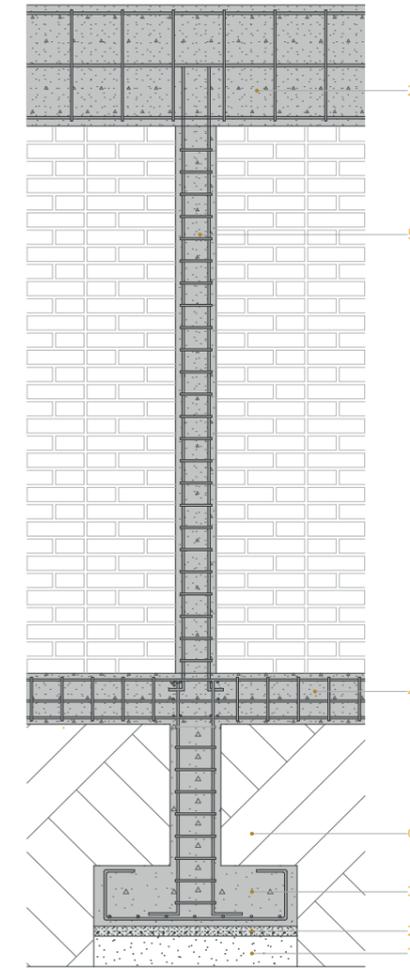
\_C4: sección constructiva\_05, refuerzo vertical para muros de contención
